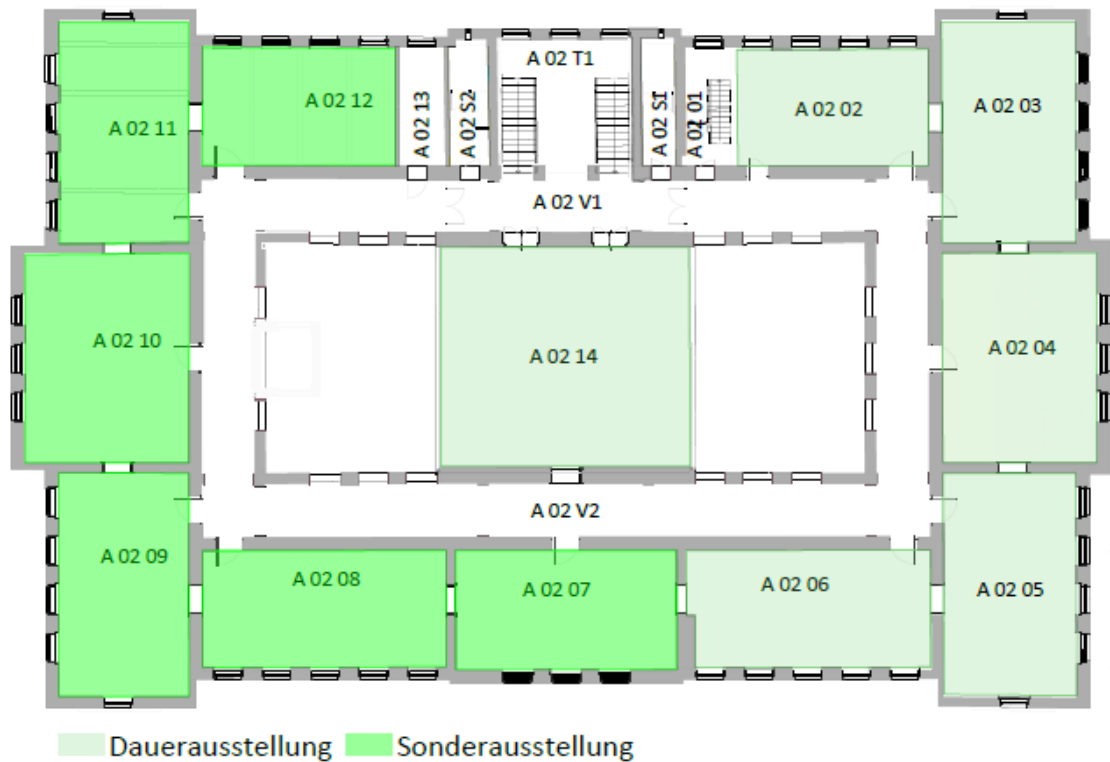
Grundriss 1. Obergeschoß
